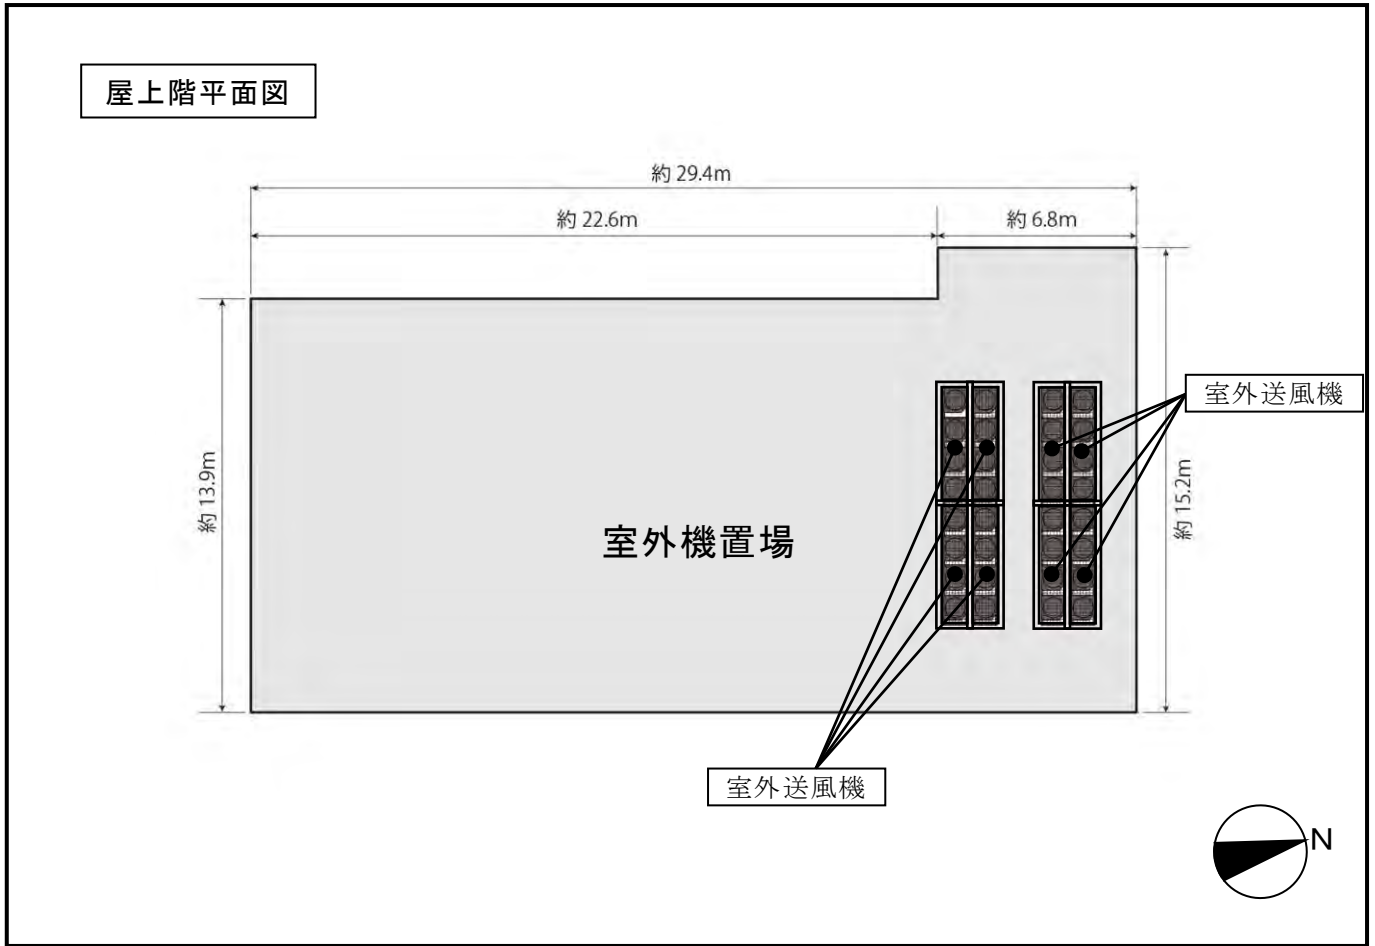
(3) 設備機器の配置図 (屋上階)
